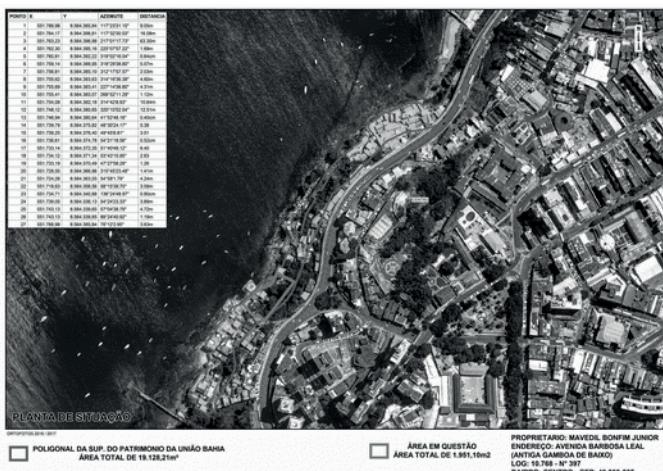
Planta de situação das ruínas do Porto da Gamboa para obras de requalificação.
